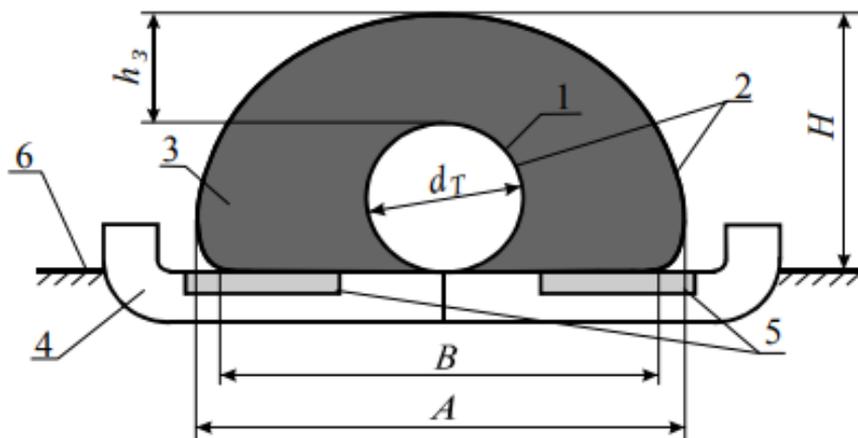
Способ наземной прокладки трубопроводов протаскиванием: 1 – трубопровод; 2 – мягкие геосинтетические оболочки; 3 – насытый в оболочку грунт; 4 – салазки-водопроемы; 5 – сдвигаемые элементы, предотвращающие размораживание водопроемов в зимний период; 6 – поверхность, по которой проходит трасса;  $h_3$  – высота защитного слоя грунта над трубопроводом;  $d_T$  – диаметр трубопровода
